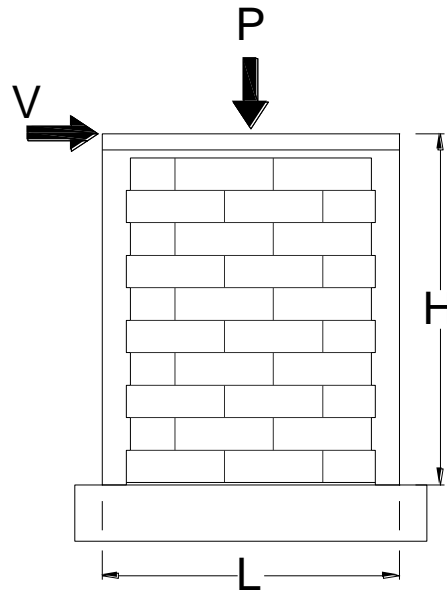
Muro confinado sujeto a carga axial y lateral
